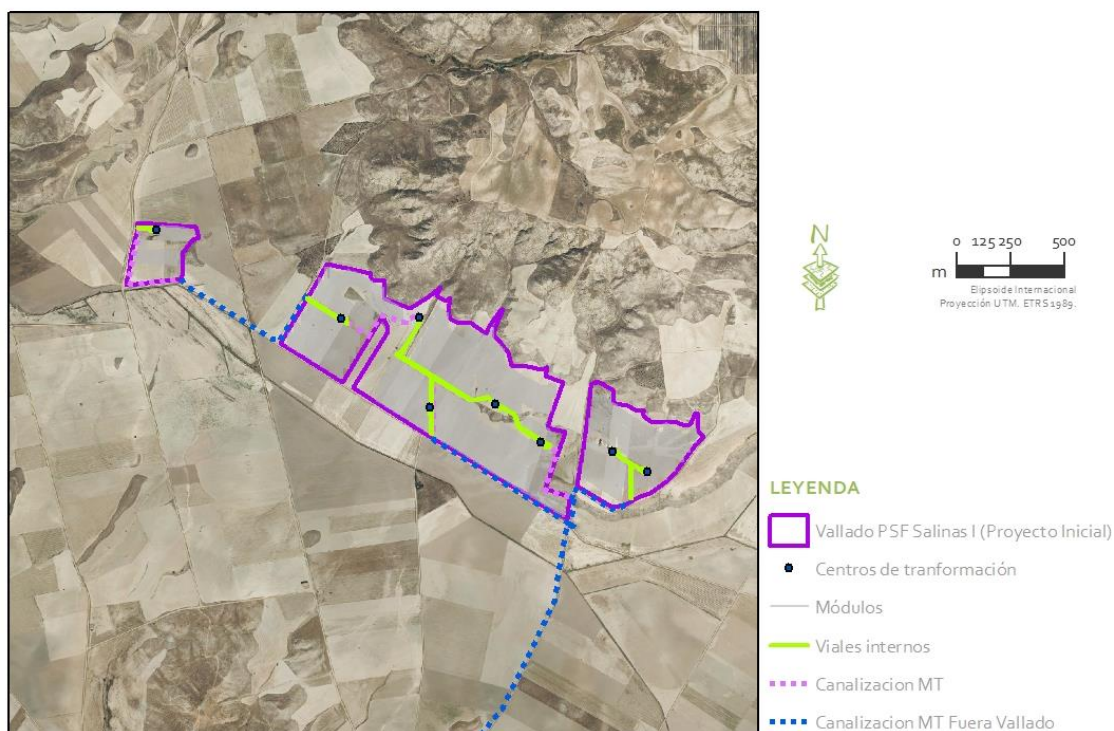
a. Diseño de la planta solar tramitada.
